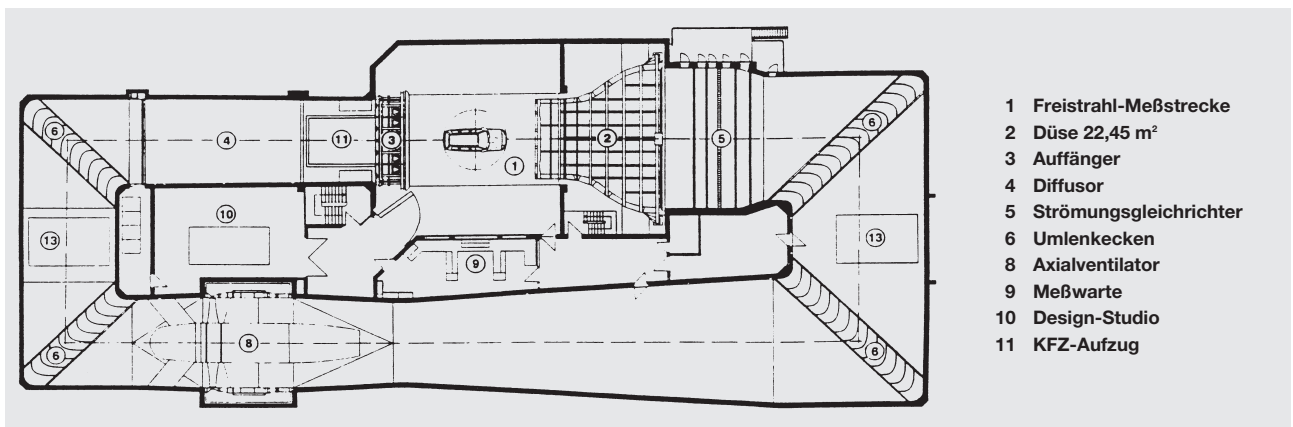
Windkanalanlage der Uni Stuttgart im Grundriß vor dem Umbau
